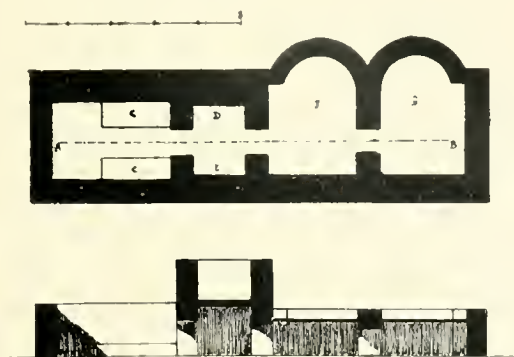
Forn de Tarragona, planta y secció (Hernández Sanahuja)
